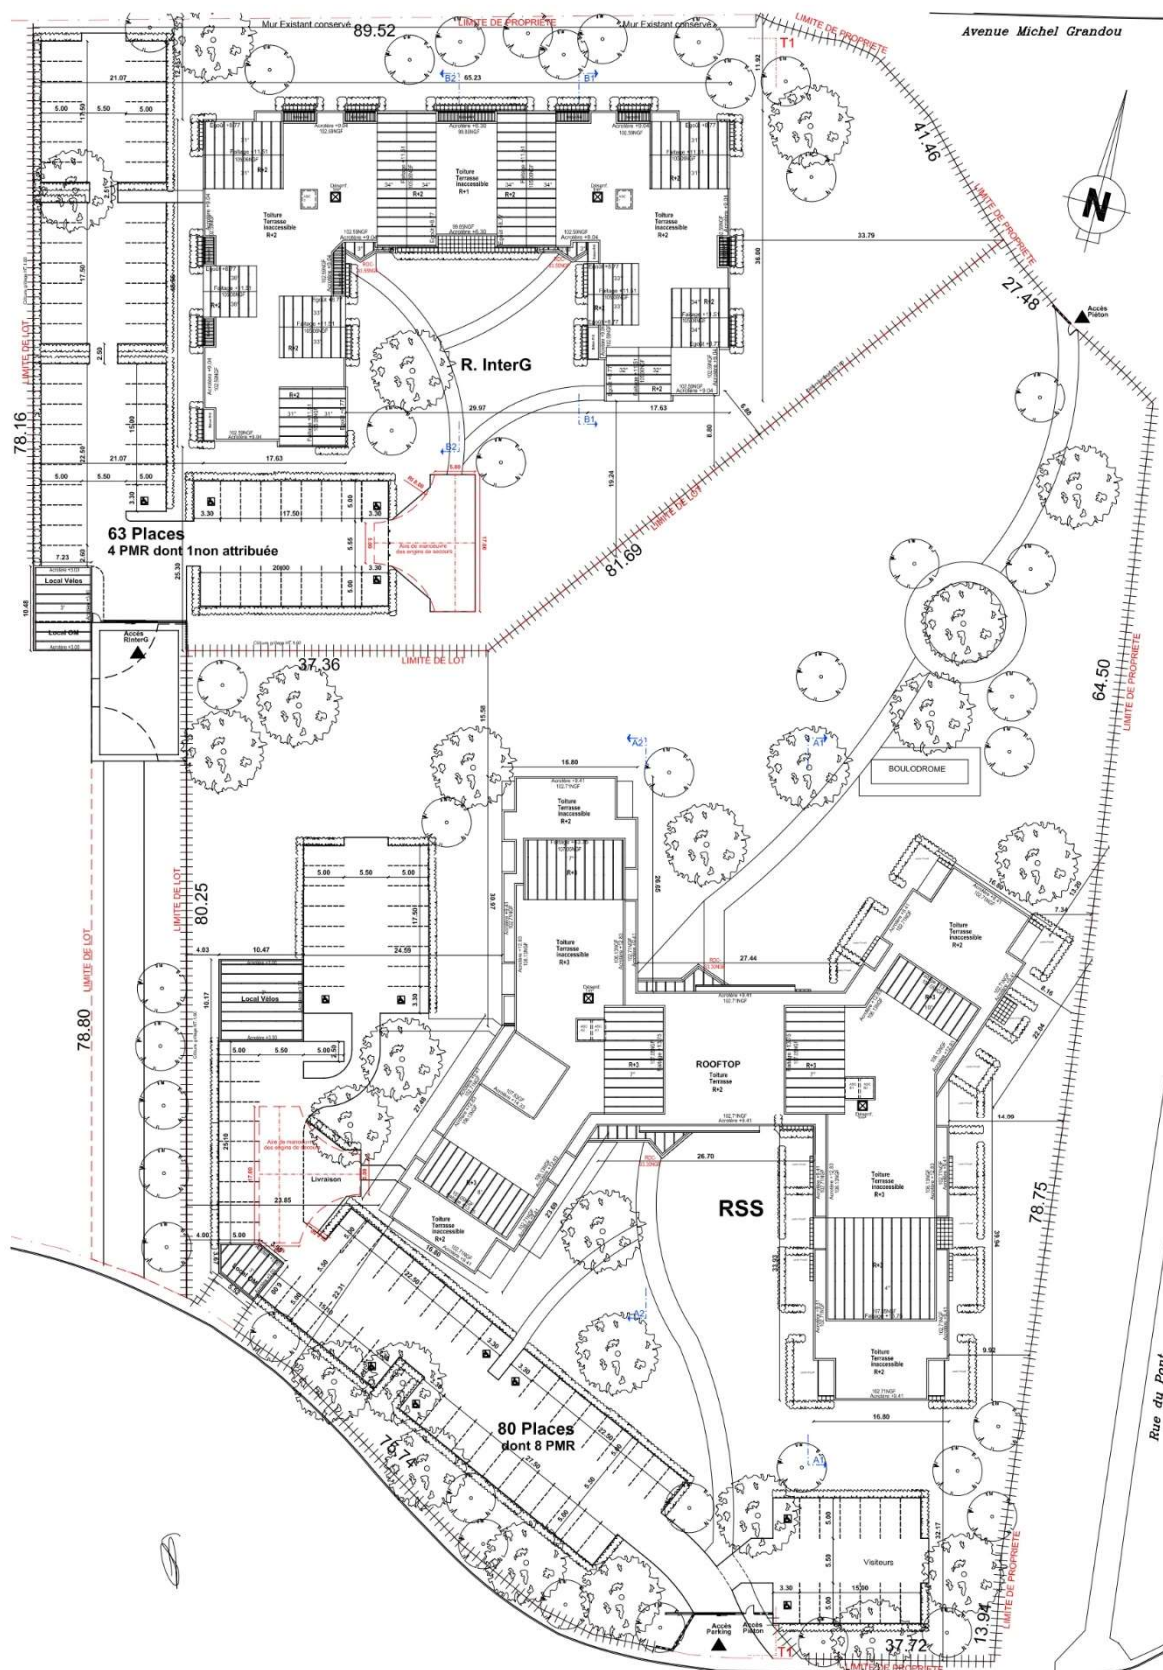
Plan masse du projet détaillé (Source : ASA Architecte ; août 2019)
